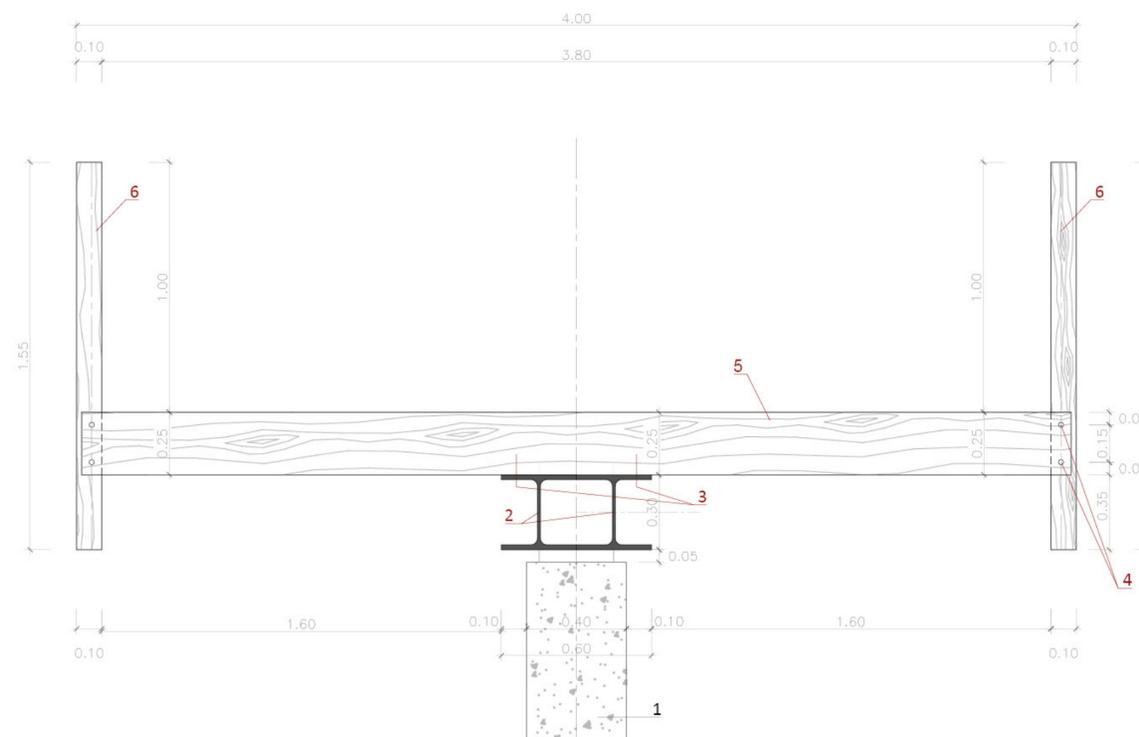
CORTE CONSTRUTIVO TRANSVERSAL B B'
